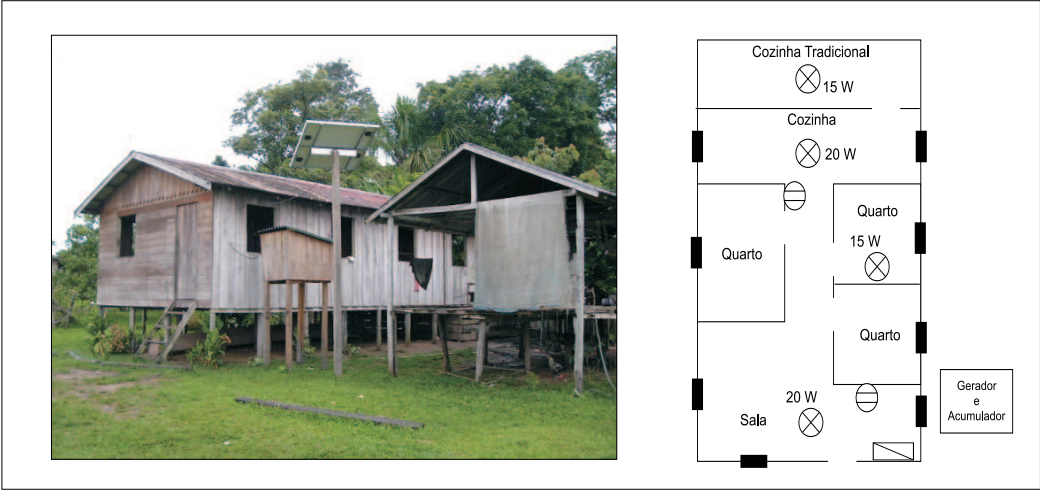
Vista externa do SFD10 e planta aproximada do domicílio.
